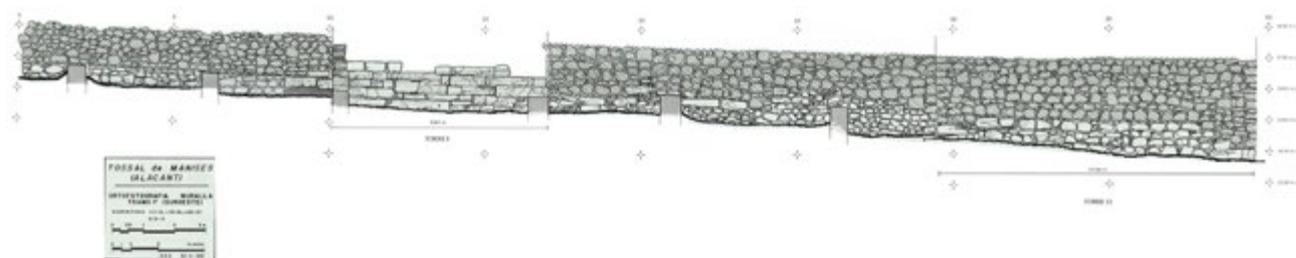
Alzado del trozo 3 del tramo 2. Tramada la parte repuesta.
